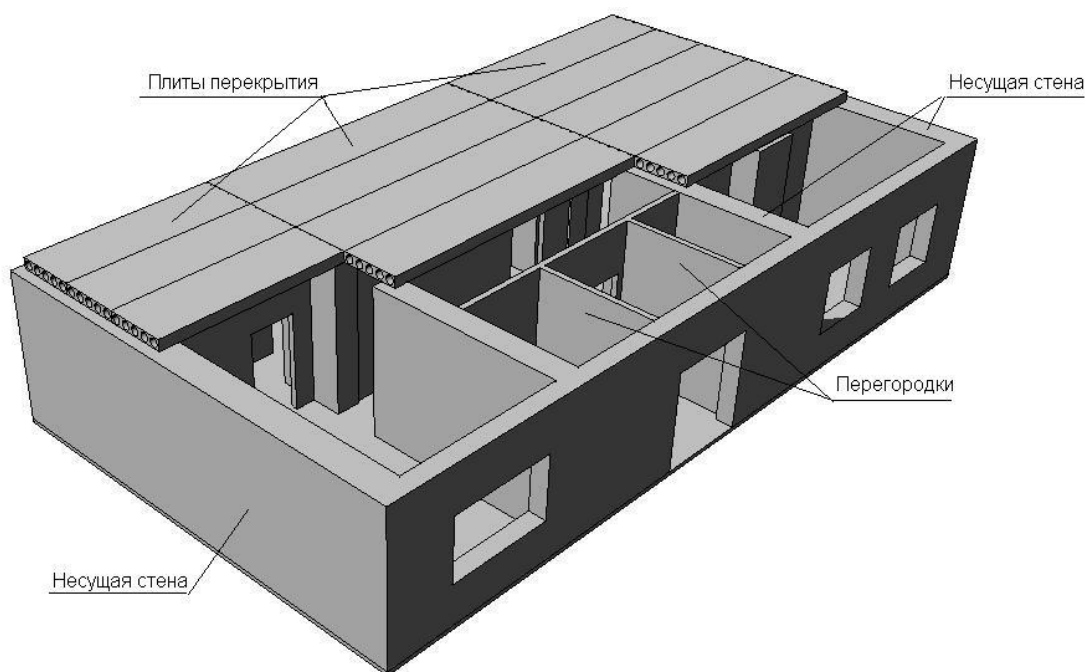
Общий вид внутренней (несущие стены, перегородки, плиты перекрытия) и внешней (несущие стены) плоскостной строительной конструкции в составе здания
